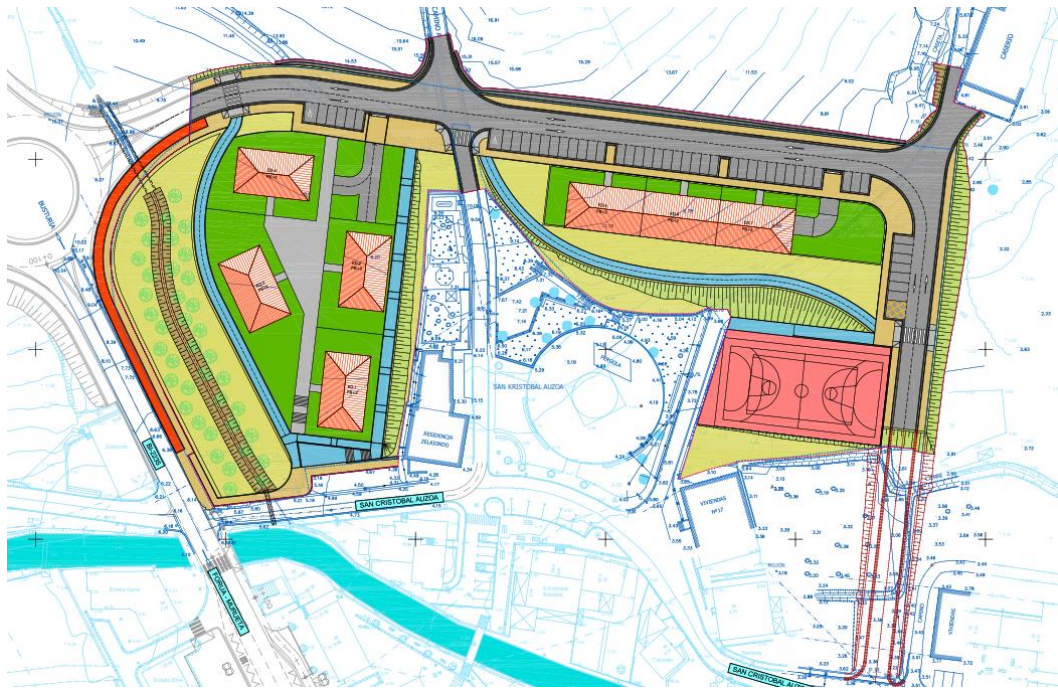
Planta General de la Actuación. Vista con los edificios completados
